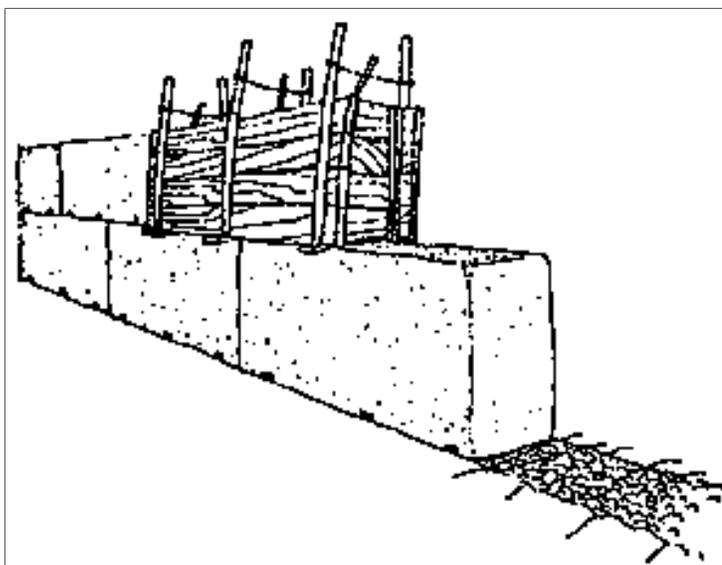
Encofrado para la fabricación de bloques de tierra apisonada. Fuente: Graham, Mchenry Paul, "ADOBE", Como construir fácilmente, México, Trillas, 1996, pp.63
